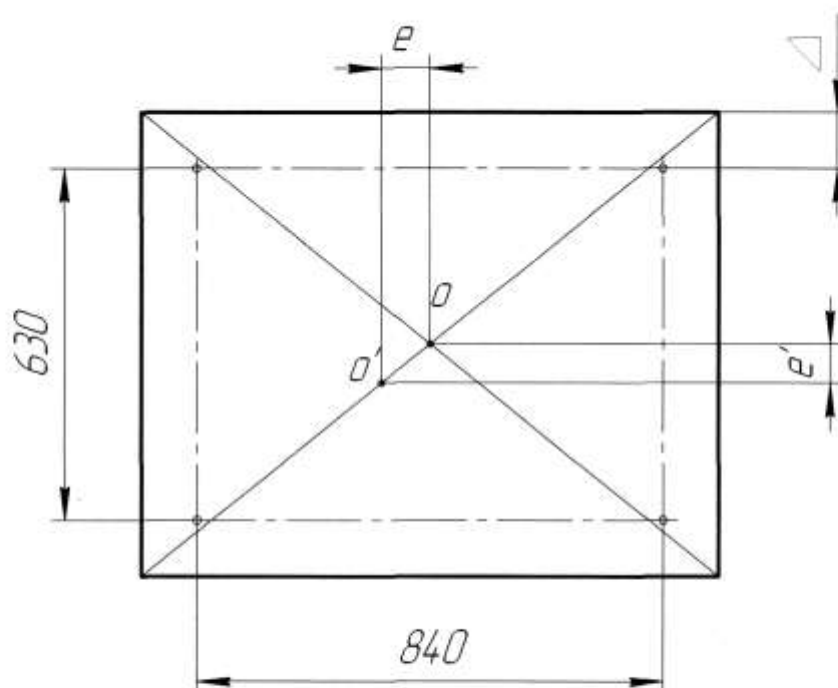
Схема фундаментной площадки под волчок К6-ФВП-1200
